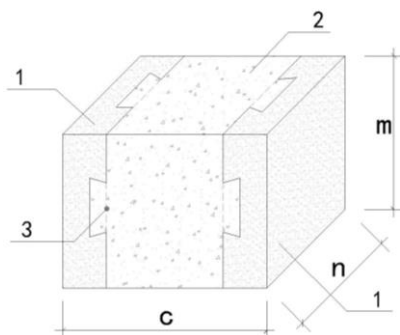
有皮混凝土试件即石材试件实样对称布置示意图
